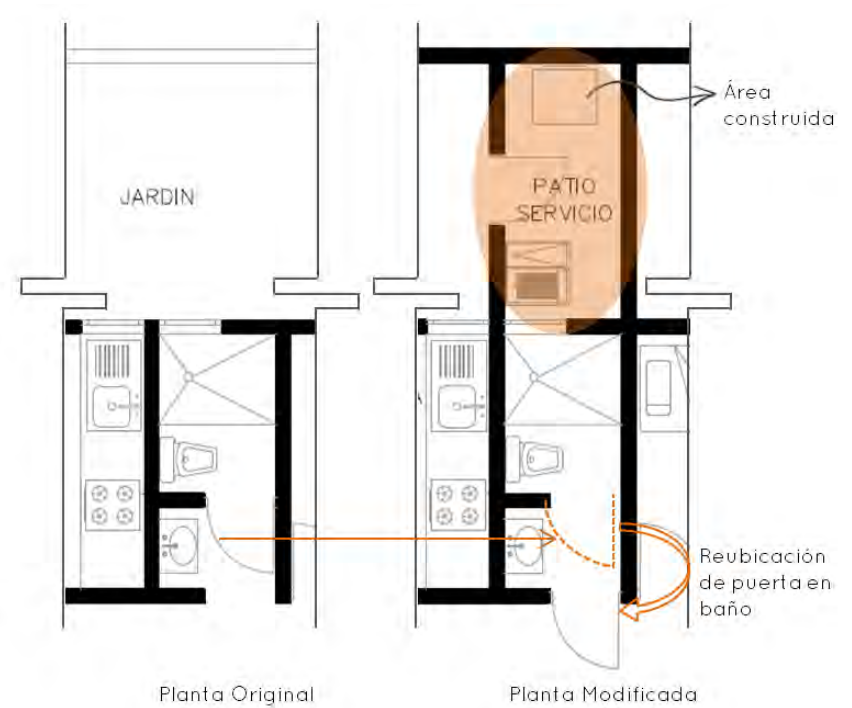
Planta actual comparada con la original, indicando las intervenciones que se le hicieron al jardín y al baño
